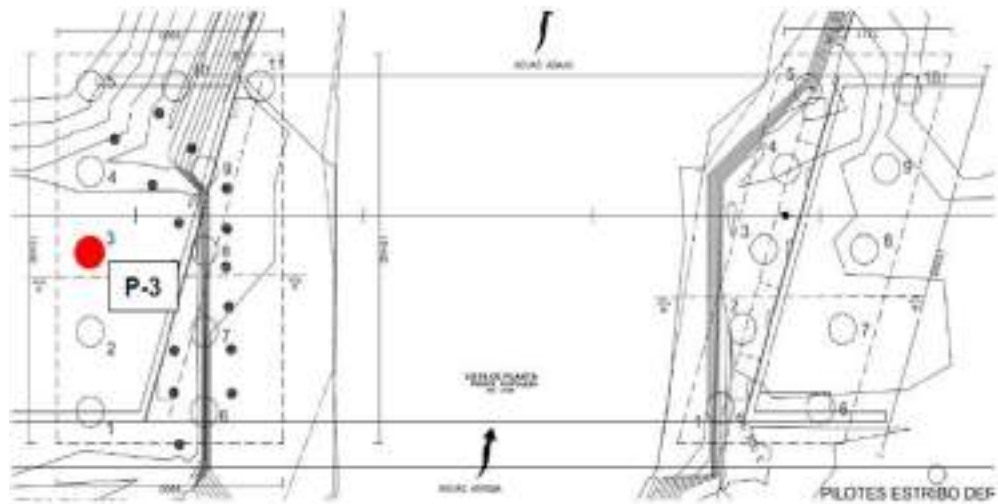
Plano en planta del Estribo Izquierdo – Puente Fortaleza.
